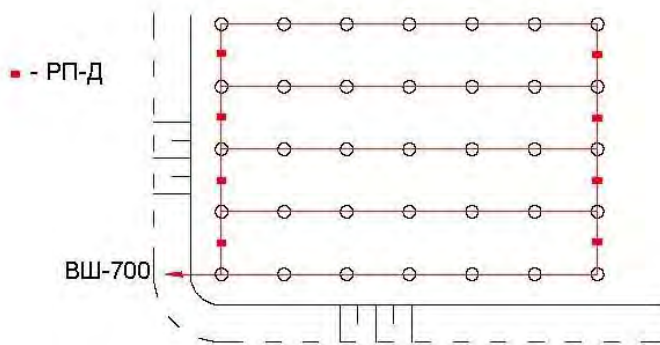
Порядная схема монтажа с применением детонирующего шнура
